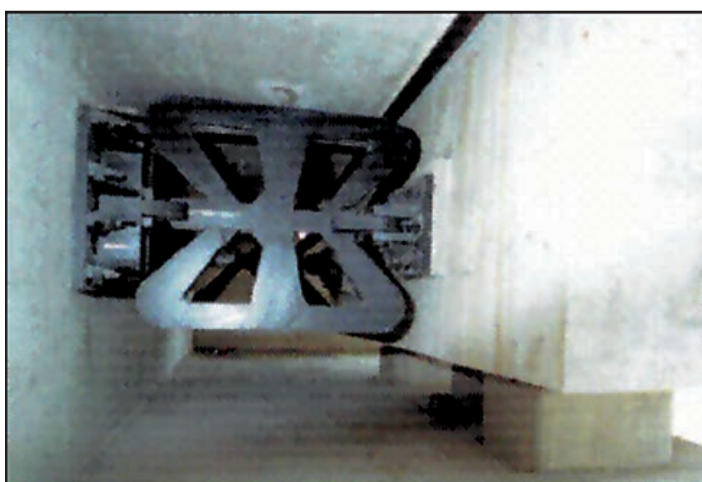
DISPOSITIVO AMORTIGUADOR ELASTOPLÁSTICO DE RETENIDA DE ESTRIBO
